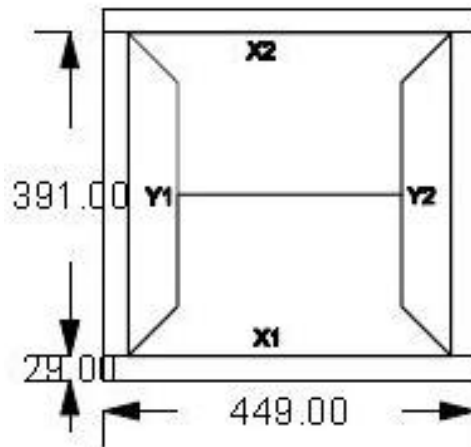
Pianta piano tipo: aree di solaio gravanti sui muri
